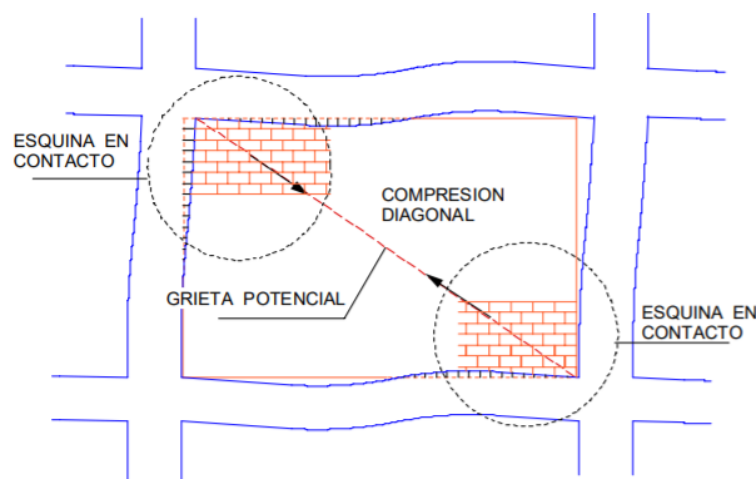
Efecto De Diagonal Equivalente Producido Por Muro De Mampostería No Estructural Adosado A La Estructura.
